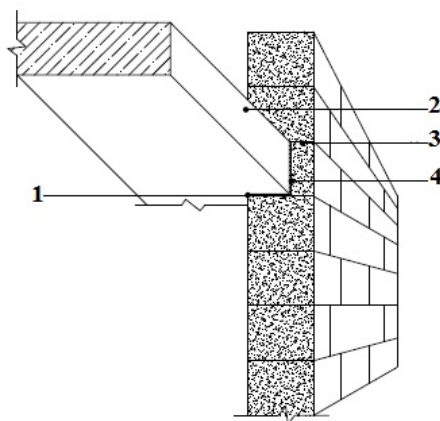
Наружная стена из газобетонных блоков и опирание на монолитный железобетонный ригель каркаса (каркасно-монолитное строительство): 1 — заполнение монтажной пеной; 2 — монолитное перекрытие (ригель); 3 — доборный блок; 4 — растворный шов
